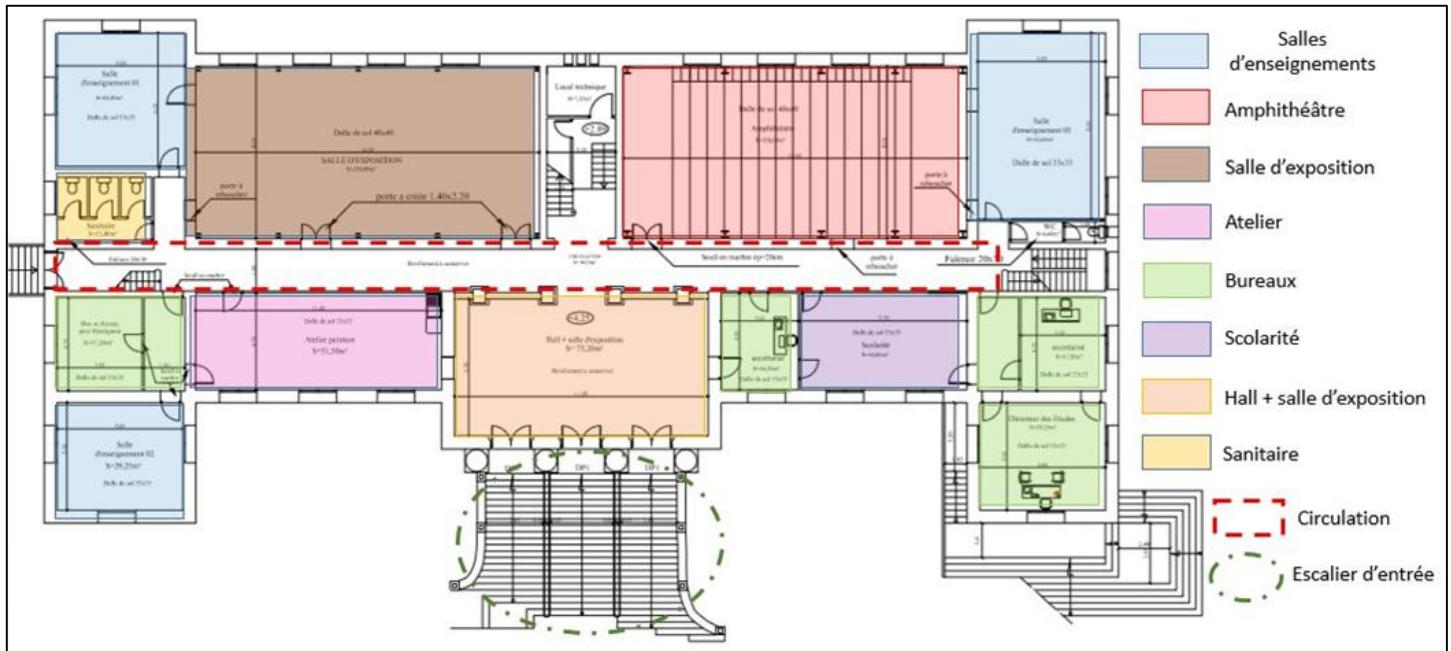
Plan RDC (Fond : plan de la direction de l'urbanisme. Traitement : auteur 2025.).
